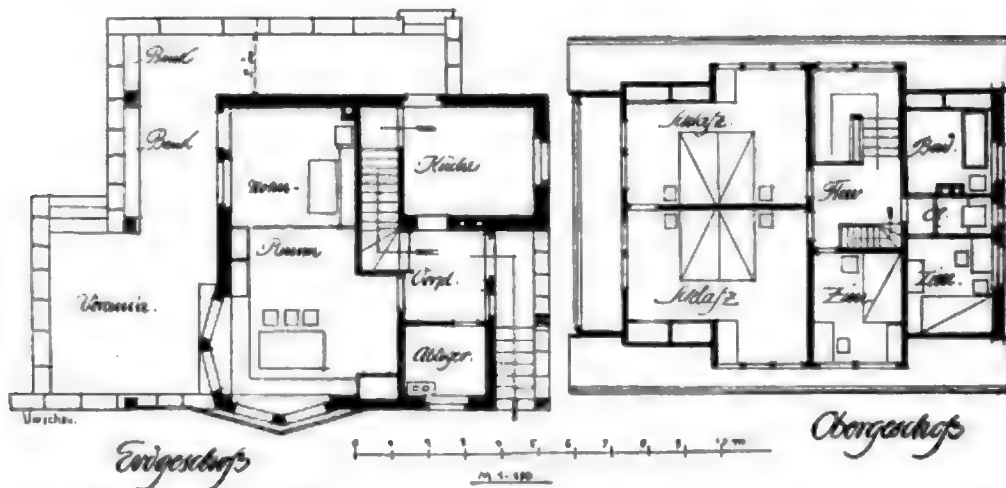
GRUNDRISS DES DEUTSCHEN LANDHAUSENTWURFS VON ARCHITEKT RUDOLF HÖLTINGEN, MÜLHAUSEN I. E.
